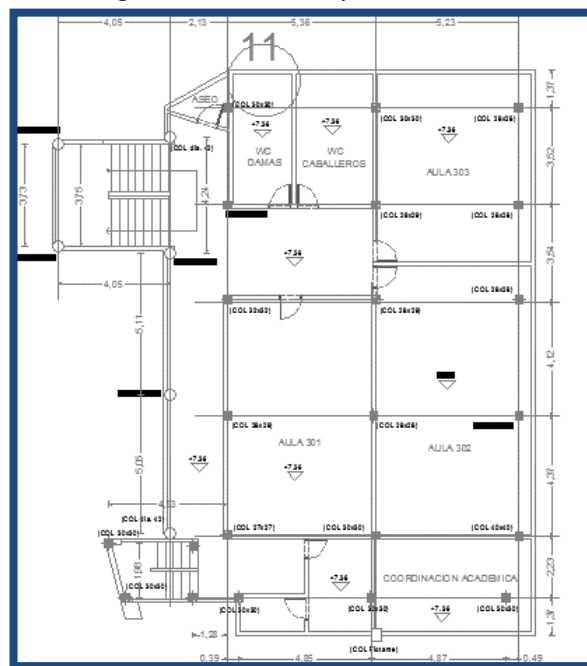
Localización en planta de la lesión #11. Fuente: Autores.
